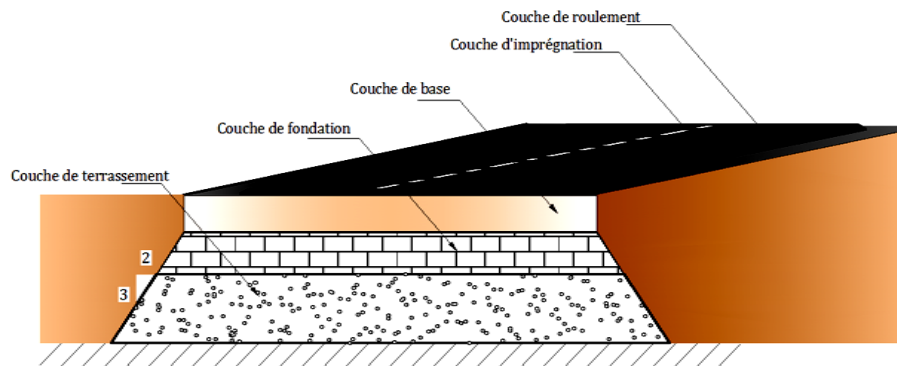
Coupe transversale type d'une chaussée saharienne.
